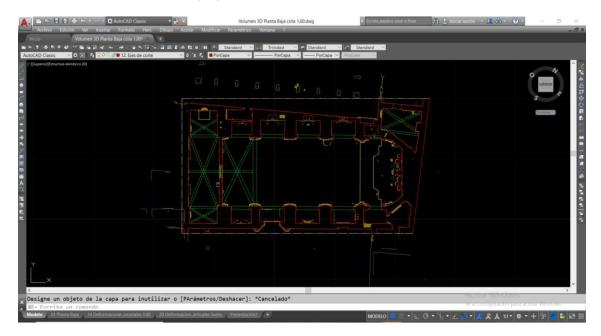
Trazado del plano de planta baja combinando nube de puntos y el grafismo que se ha ido realizando ELABORACIÓN PROPIA
